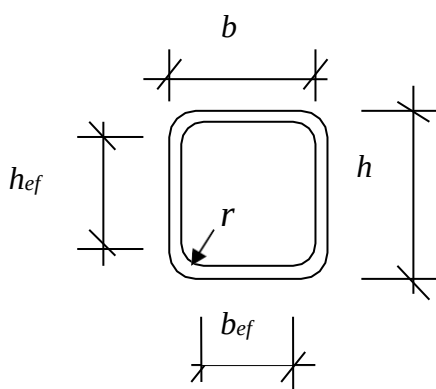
Сечение ГСП. К расчету на местную устойчивость стенок и полок
